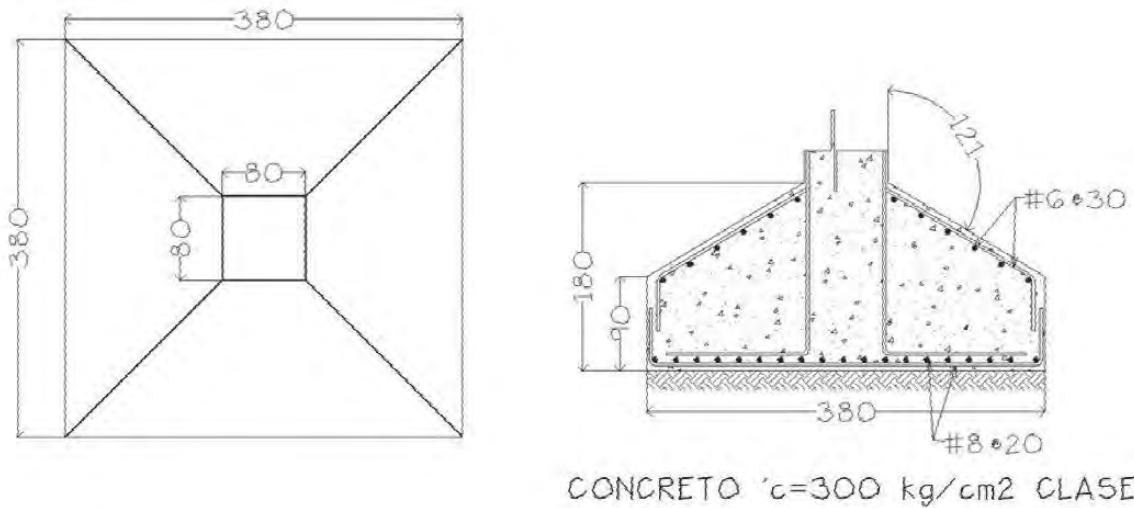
Solución al cambio de pilas por zapatas en las intersecciones de los ejes 1-A, 2-A y 1-B
